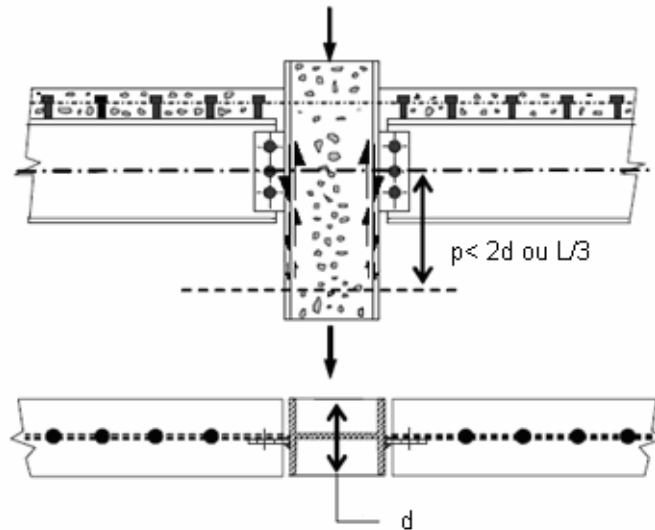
Transferência de forças numa união mista viga-pilar
